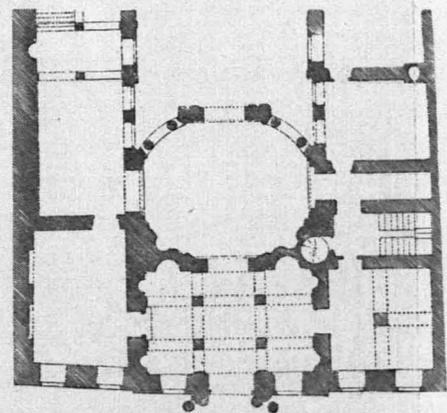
Grundriß der Eingangshalle des Daunschen (jetzt Kinskyschen) Palastes in Wien, nach Alb. Niemann, s. nebenan
